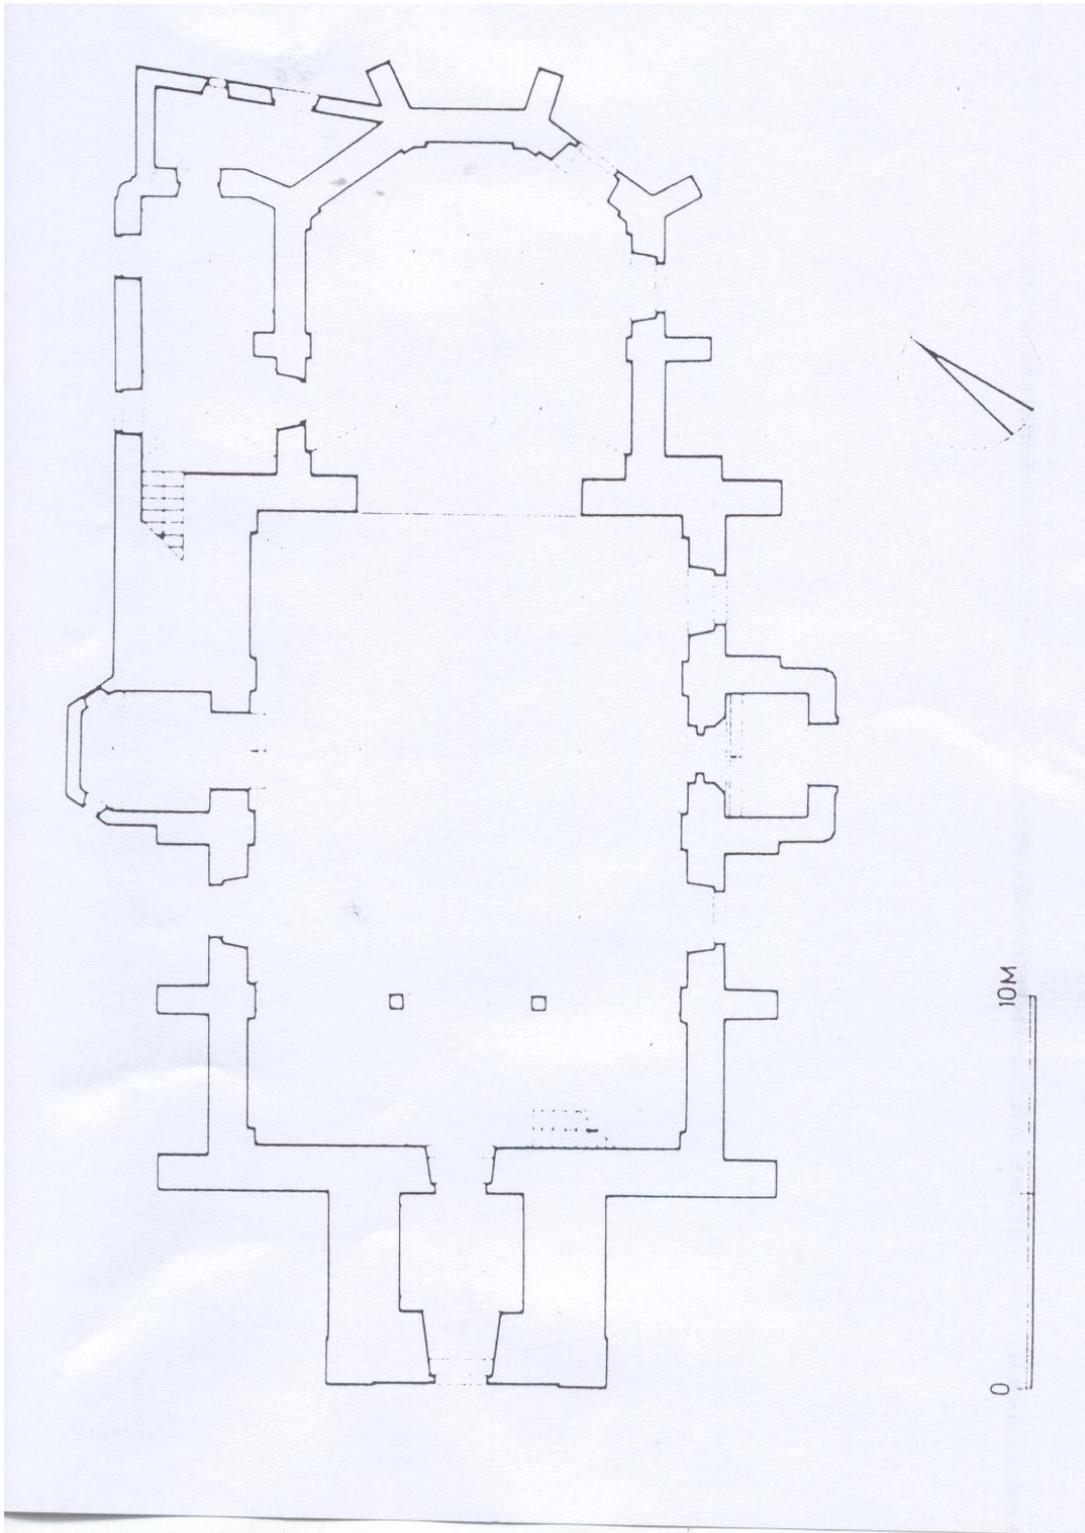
, Grundriss 10, Marz, Pfarrkirche³³²
